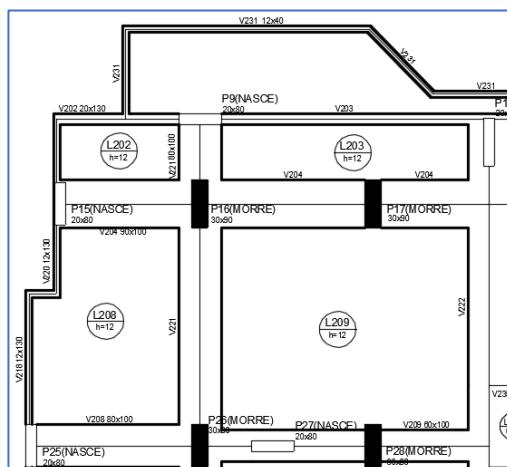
Trecho da forma estrutural – Pilares em transição. Fonte: Autores
